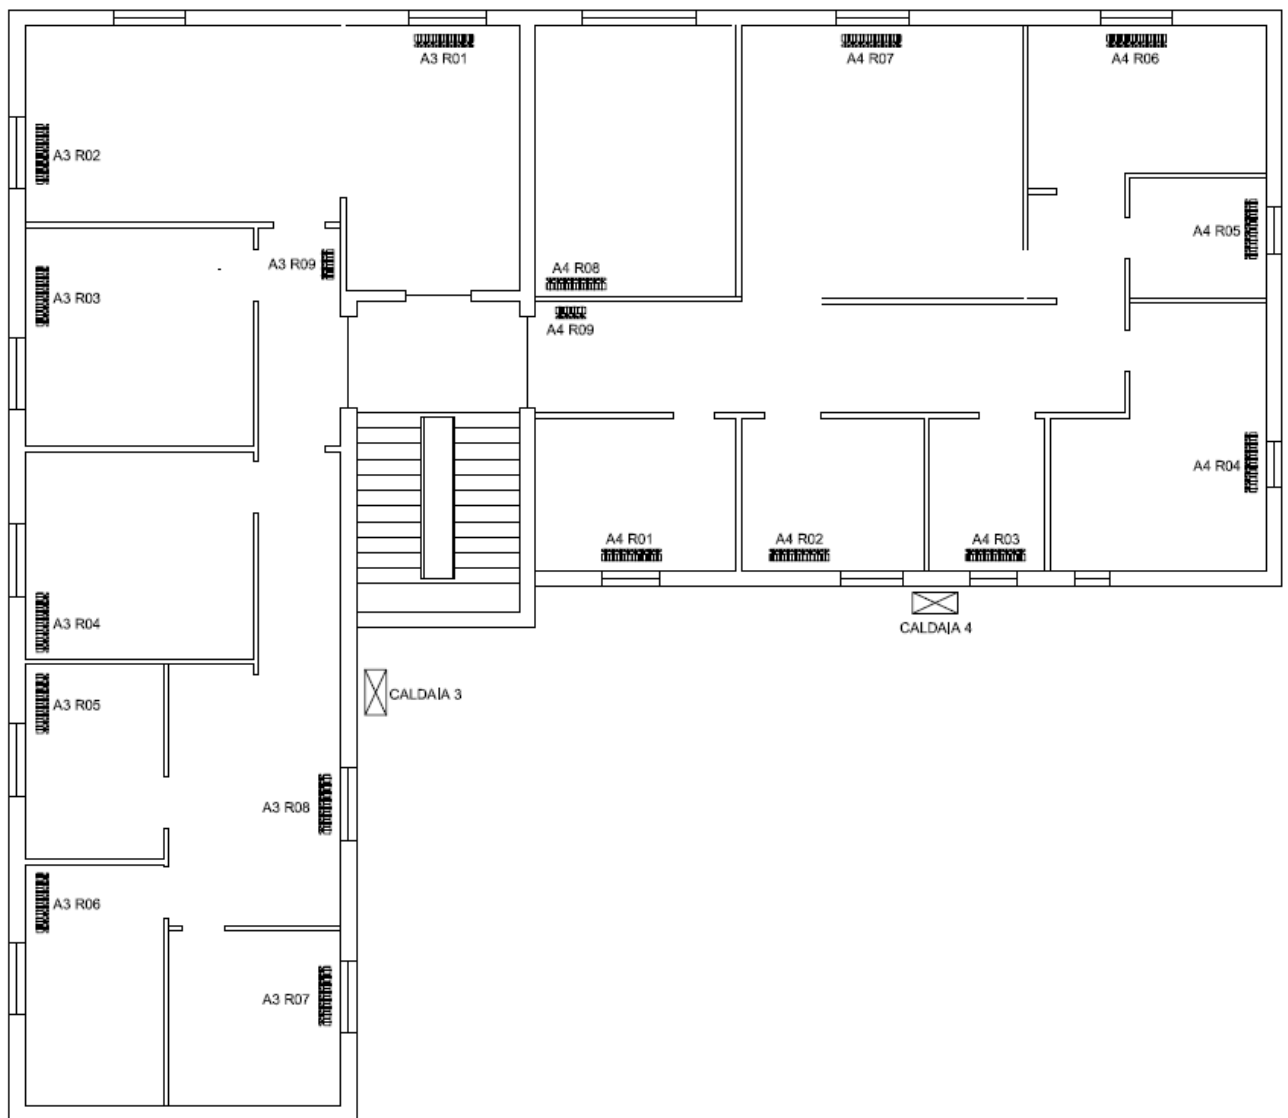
Planimetria Piano Secondo (AP_3 e AP_4)
